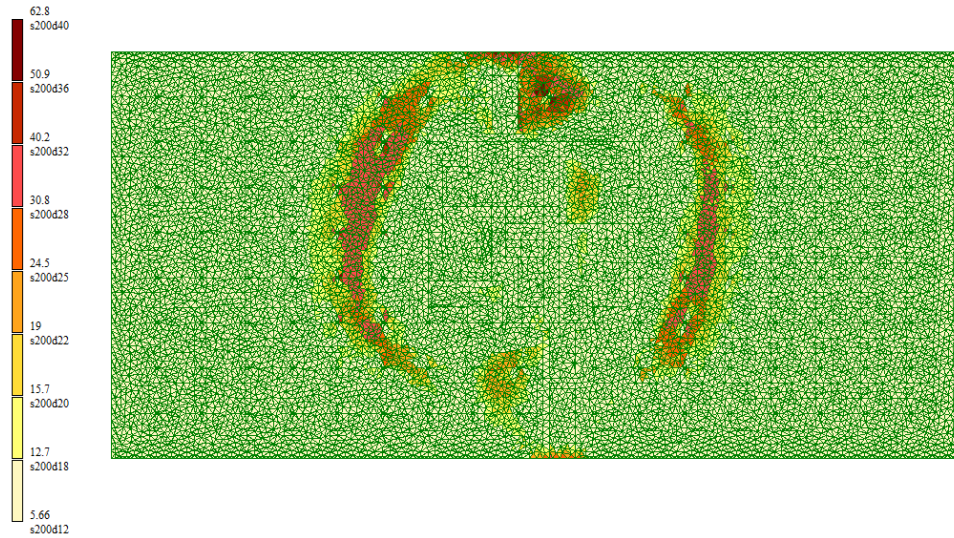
Схема армирования фундаментной плиты по оси X (у верхней грани)
